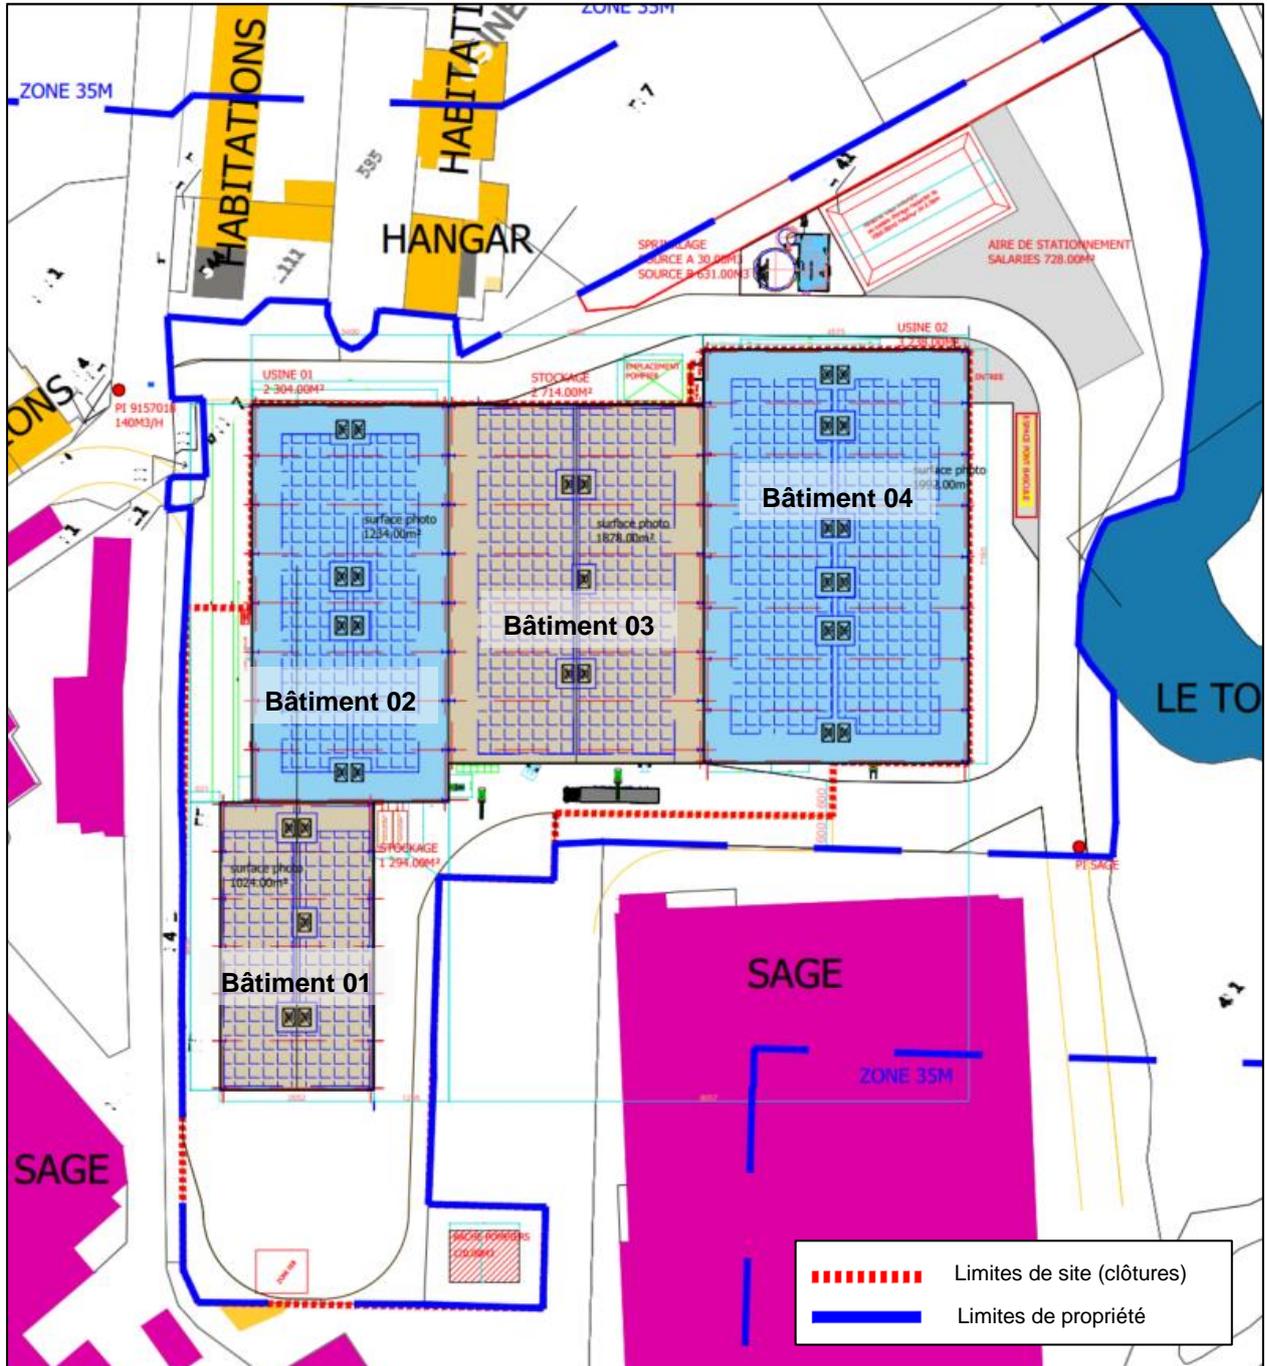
Plan de masse du projet (vue des toitures des bâtiments)
